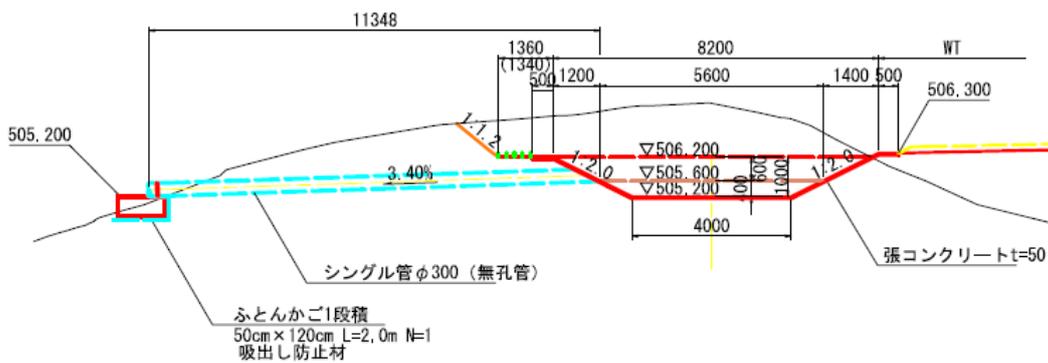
濁水処理設備（沈砂池）の例
